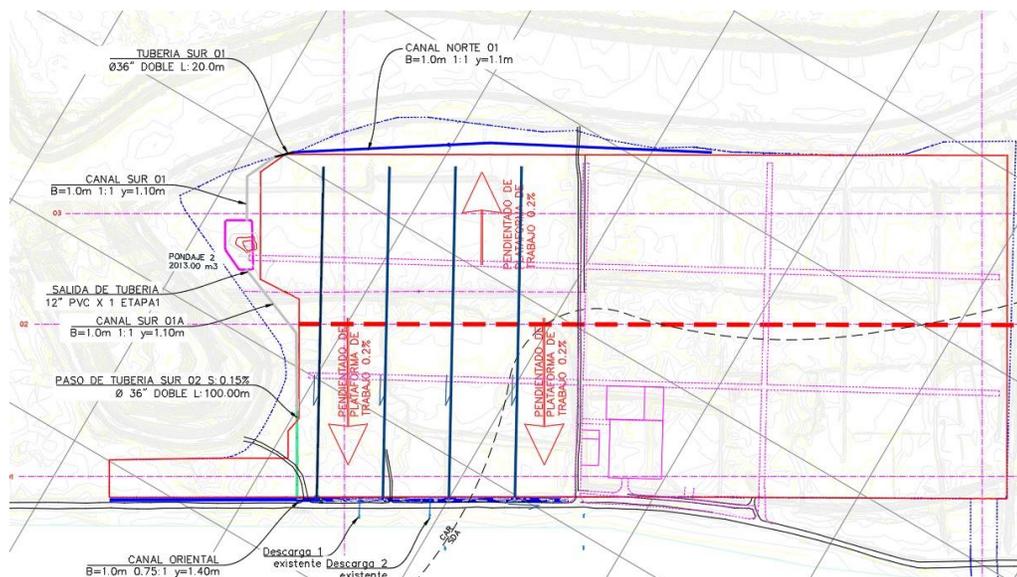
Localización de obras de drenaje en la plataforma en la etapa de construcción
